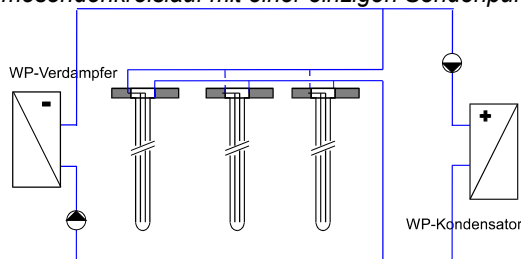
Erdwärmesondenkreislauf mit separater Lade- und Entladepumpe.
